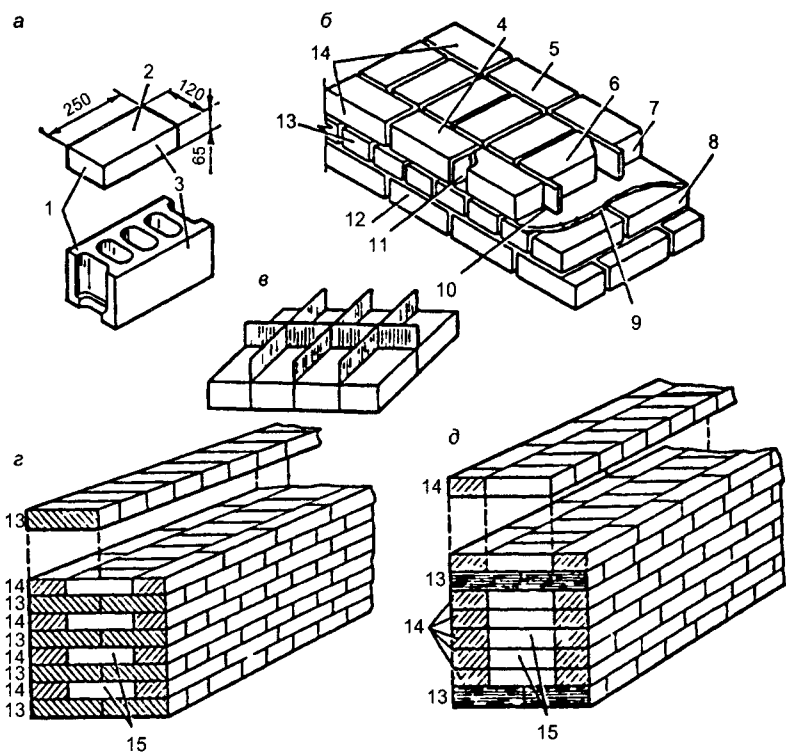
Элементы кладки, правила разрезки и системы перевязки кирпичной кладки:
